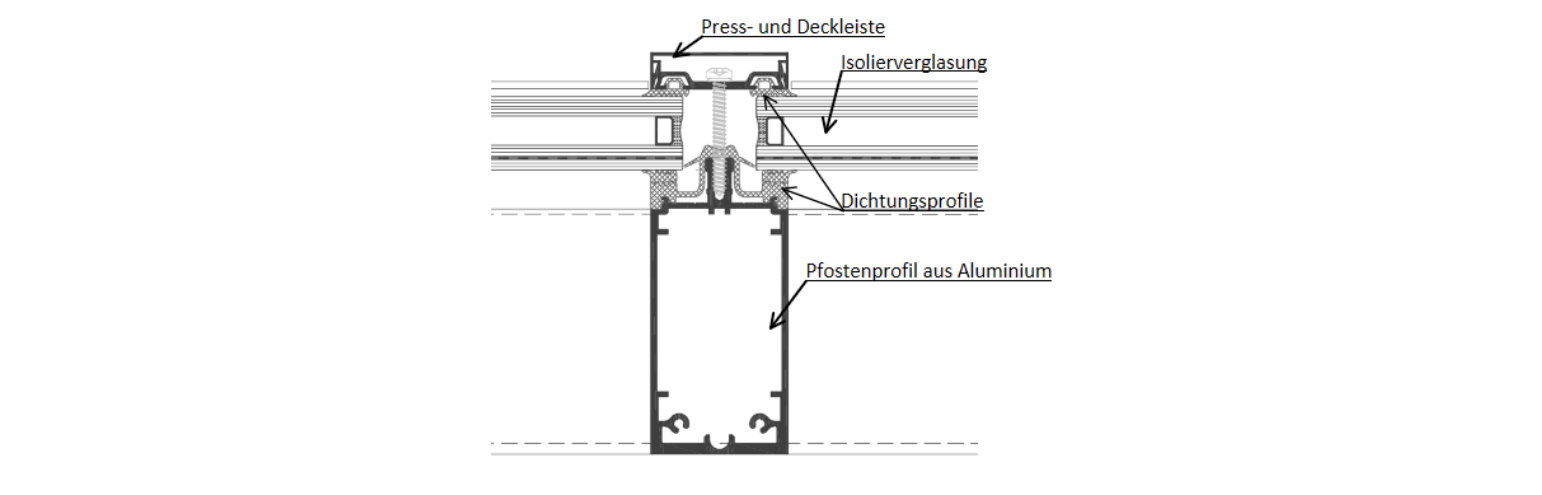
Detail Mehrscheiben-Isolierglas horizontal
